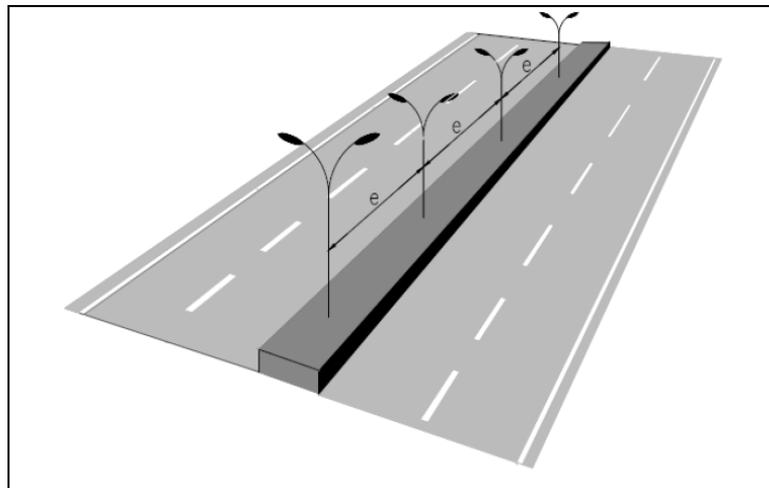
Penempatan Lampu Penerangan Jalan pada Jalan Dua Arah di Kiri atau Kanan Jalan
